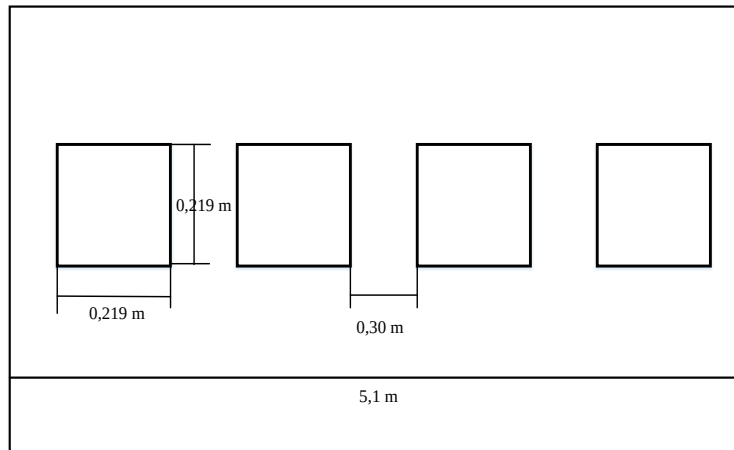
Disposición de las aberturas en el tanque séptico. Fuente. Elaboración propia
